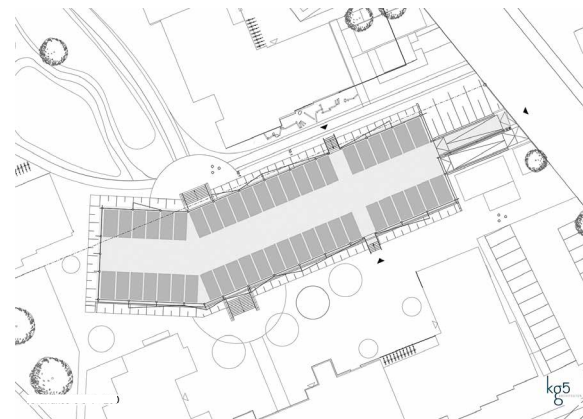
Grundriss OG (© kg5 Architekten)
